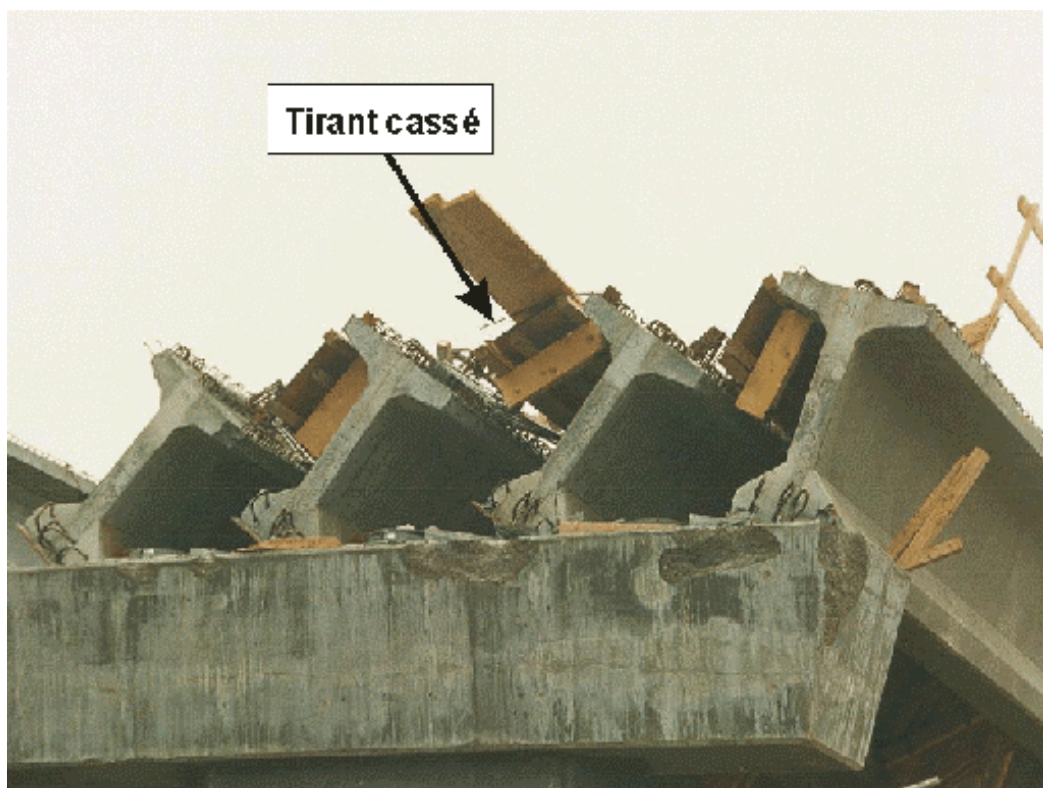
Vue rapprochée du bout des poutres 1 à 4 de la travée 4 (photo SQ-B20)
